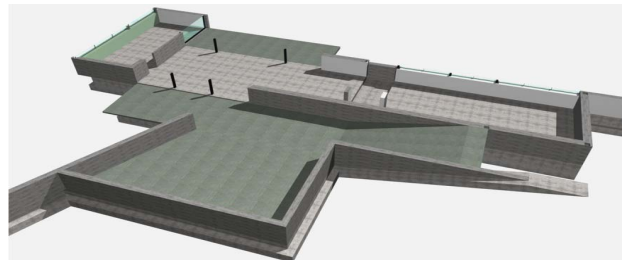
Maqueta estructural filtrada seccionada por la planta de acceso. 2012. Curso Interoperabilidad. Cfp. Universidad de Sevilla
